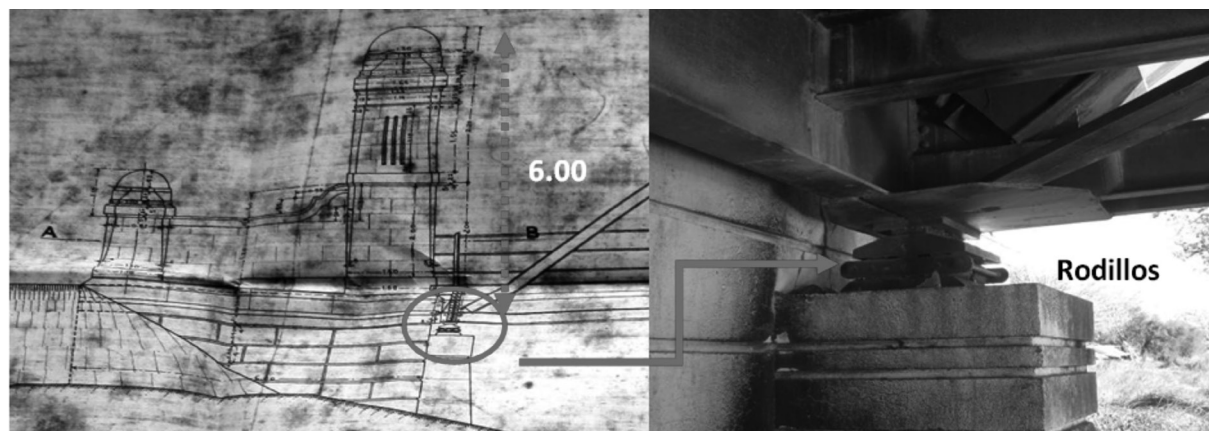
Plano de obra. Sección transversal del muro y comienzo de la superestructura. Fuente: Dirección de Hidráulica Sección Dolores.
